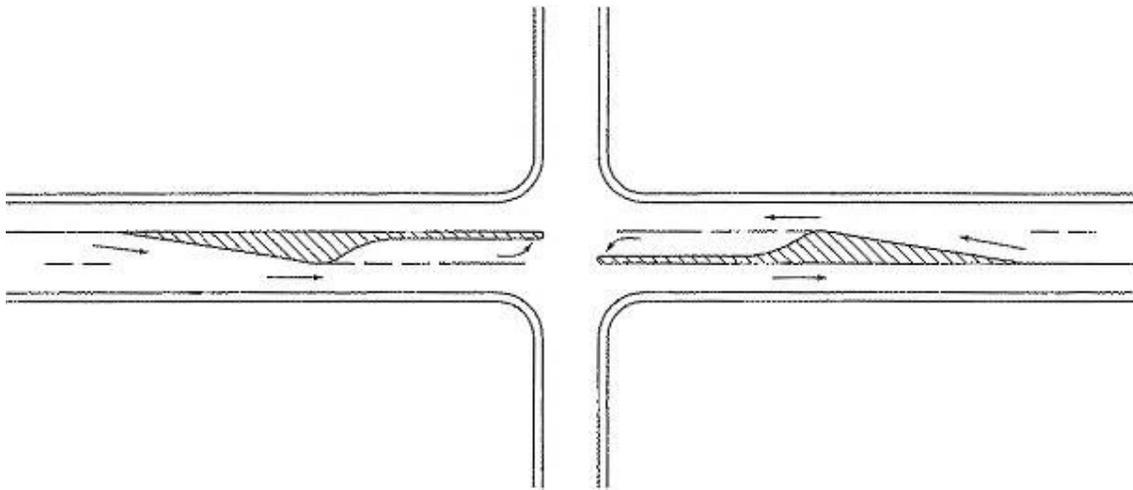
Esquema de intersección de cuatro ramales en una calzada 2+1
